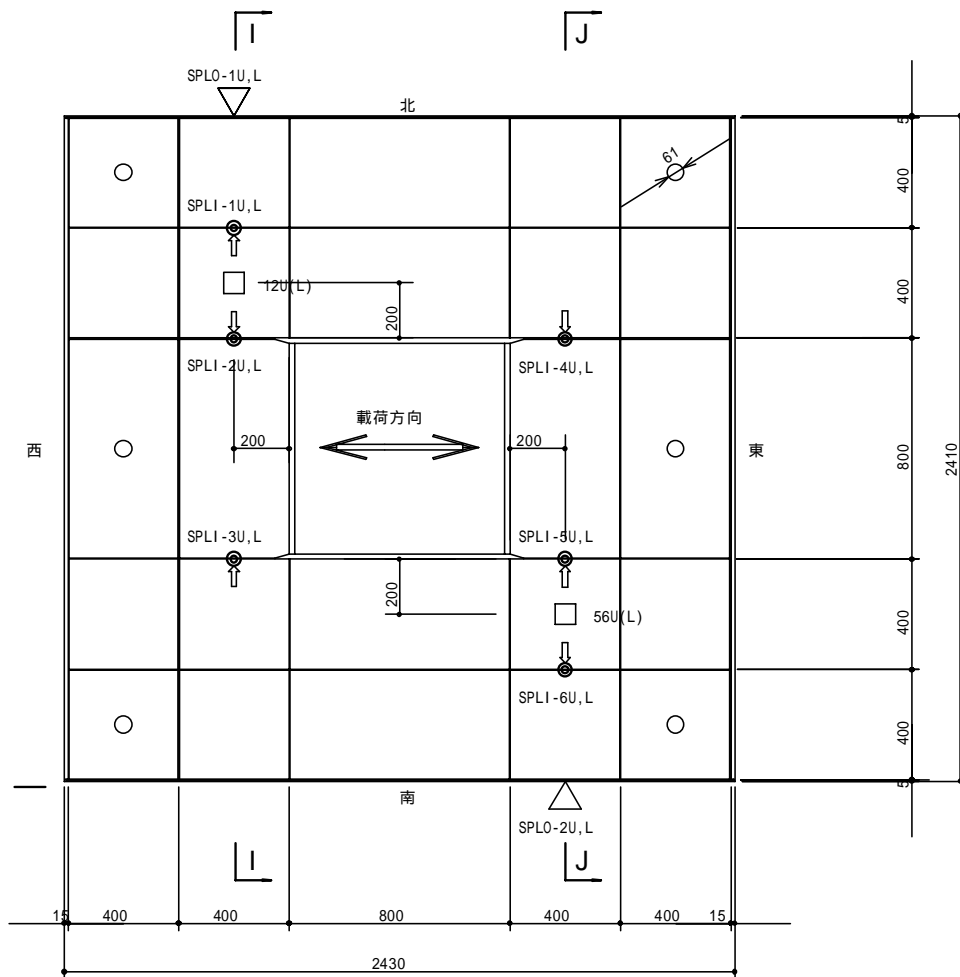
下面鋼板ひずみ計配置図 (F-1 試験体)
